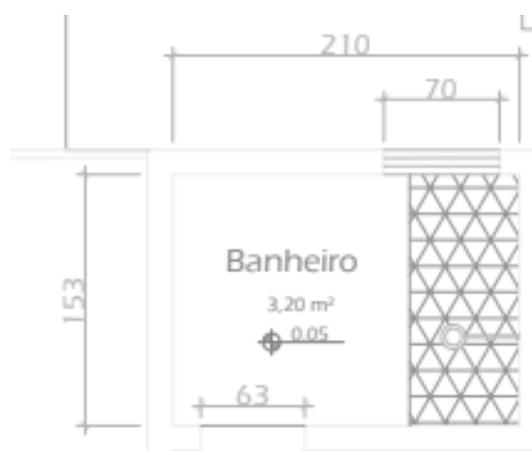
Planta do banheiro a ser reformado. Fonte: Acervo pessoal.
